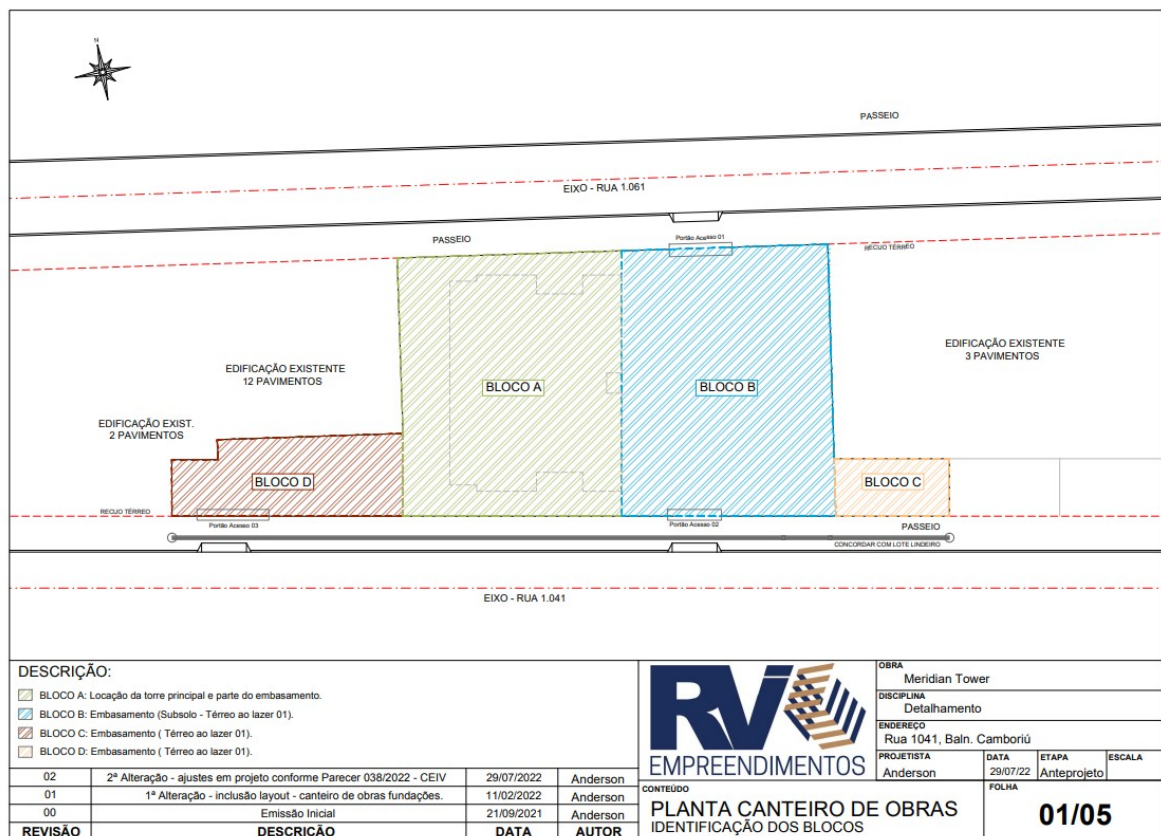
Projeto do canteiro de obras. Prancha 01/05
